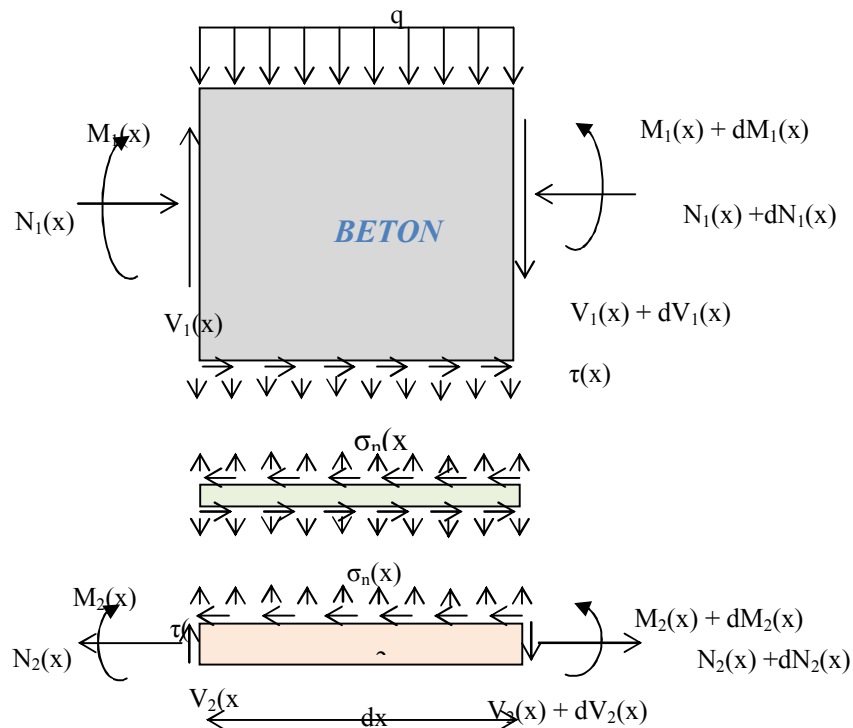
un segment différentiel de la poutre renforcée par collage de composite.
